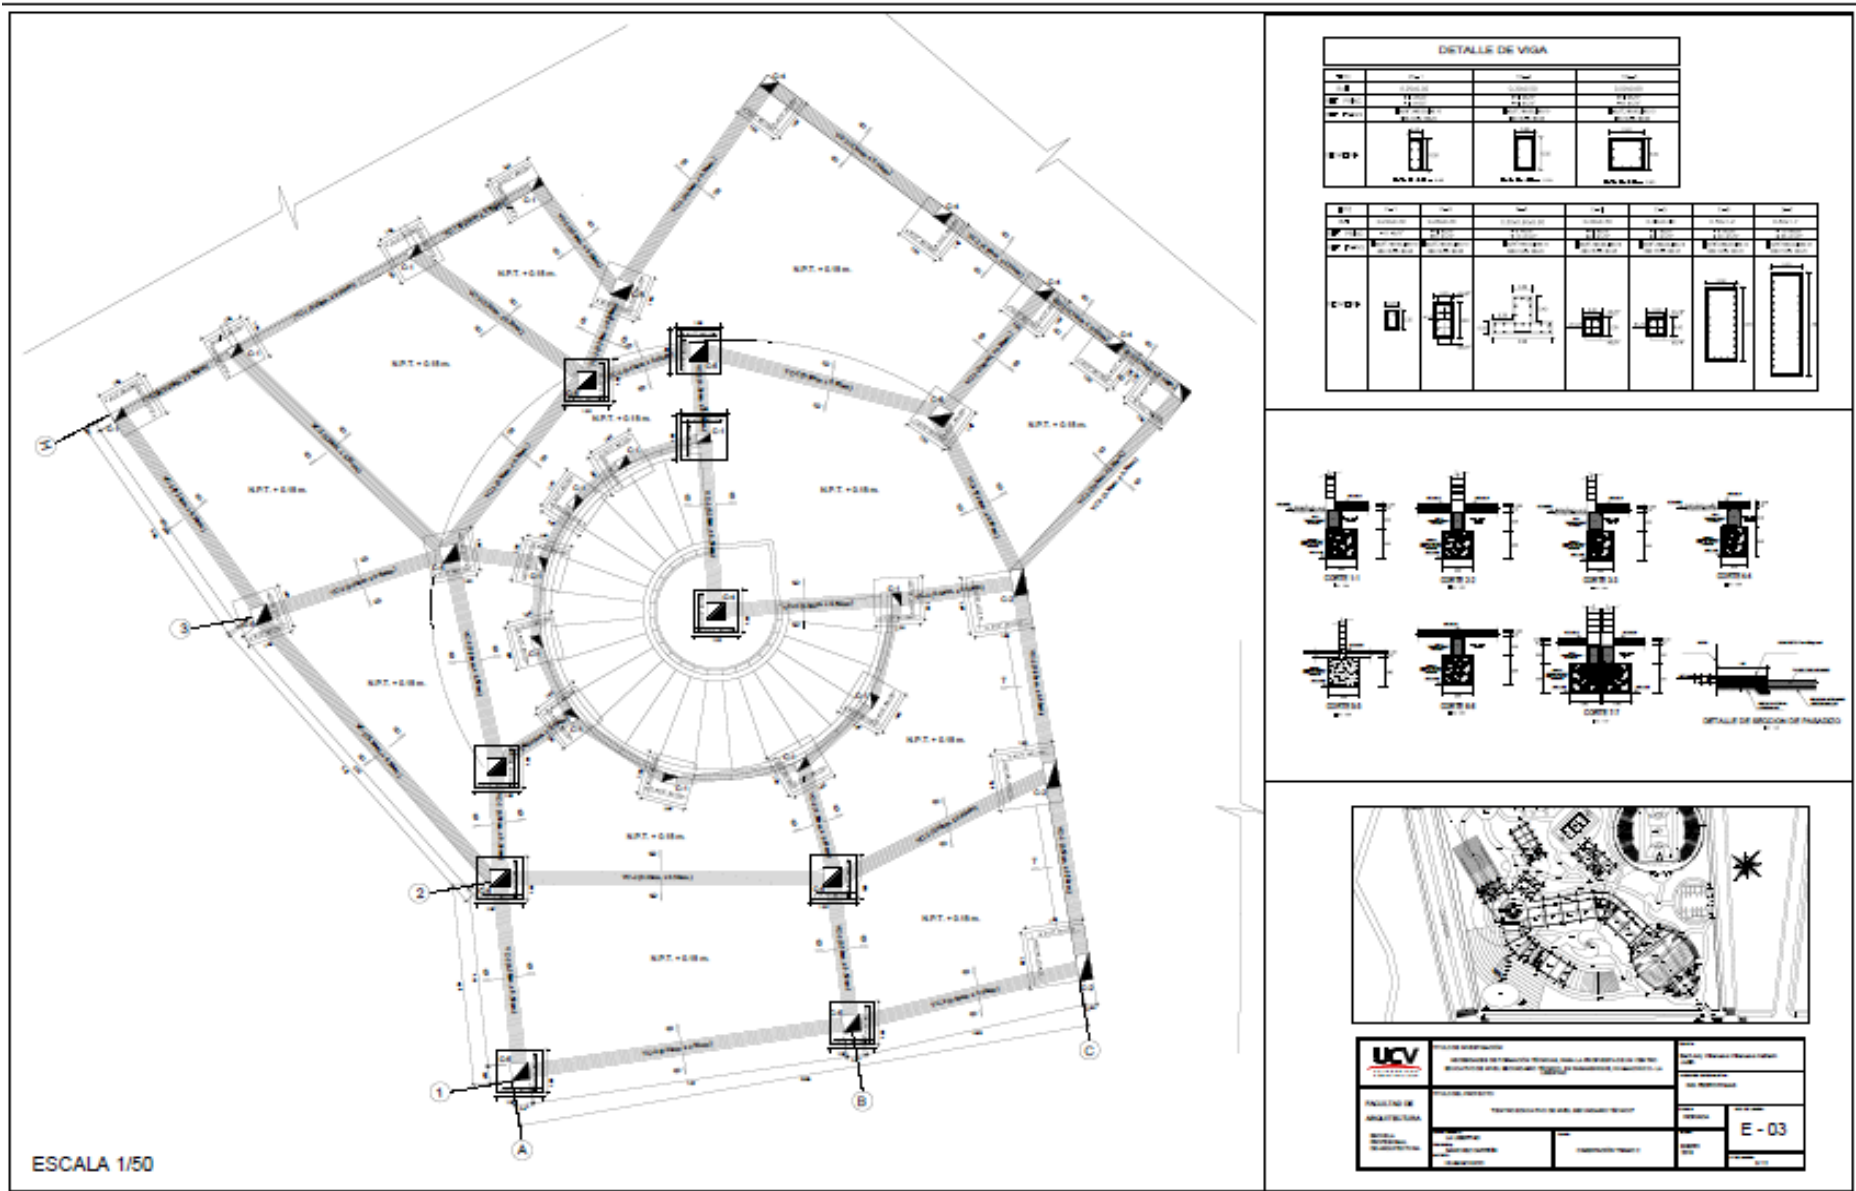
Plano Diseño Estructural Bloque 02 – Cimentación - Plano N° 11 - Lamina E-03
